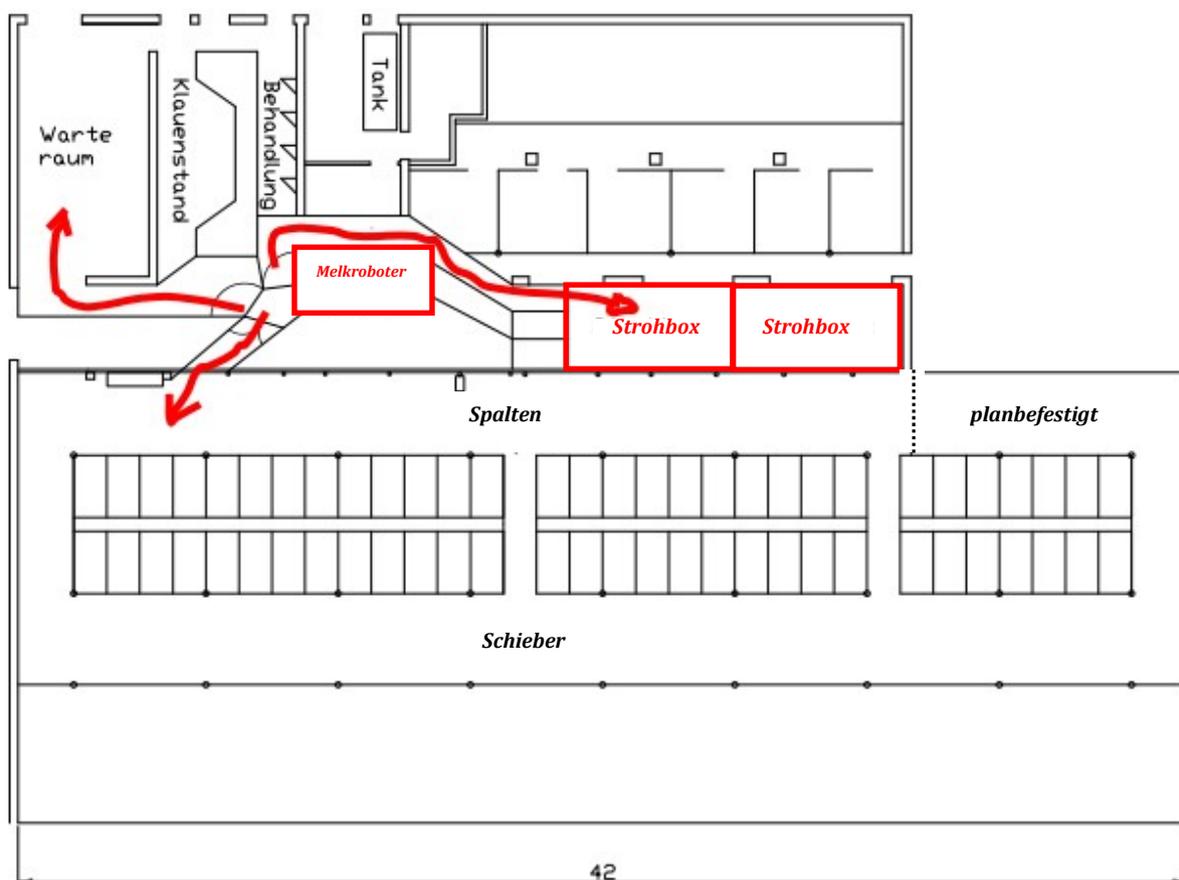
Grundriss Stallumbau auf Melkroboter für 60 Kühe
